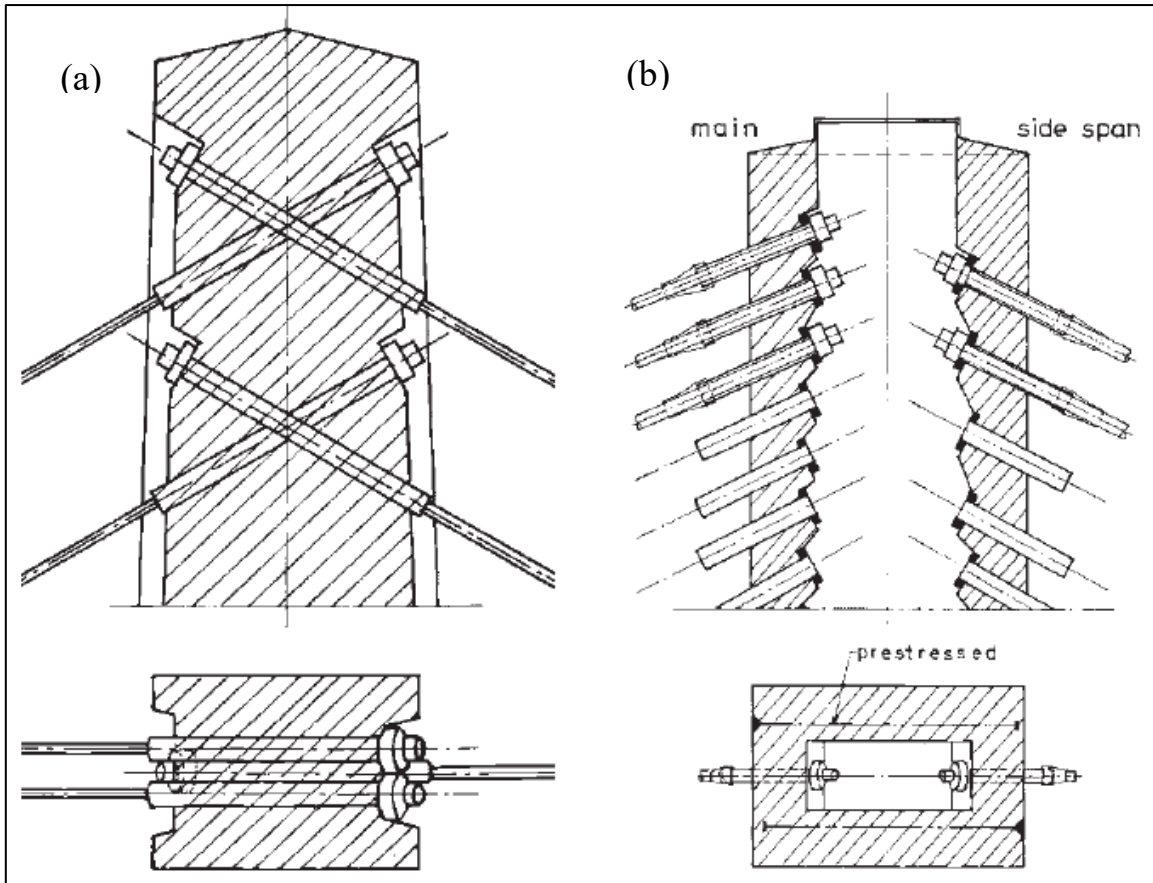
(a) Anclaje con cables traslapados y (b) Anclaje en sección cajón (Svensson, 2012).
